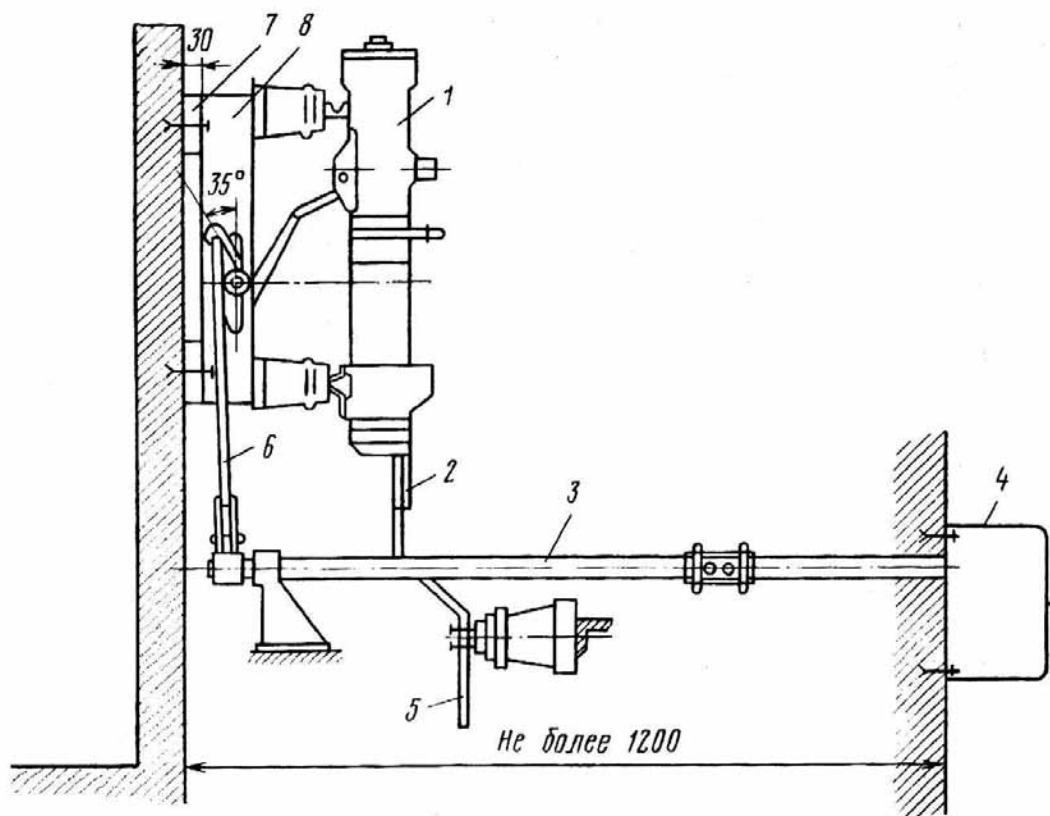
Общий вид установки выключателя ВМП-10:
